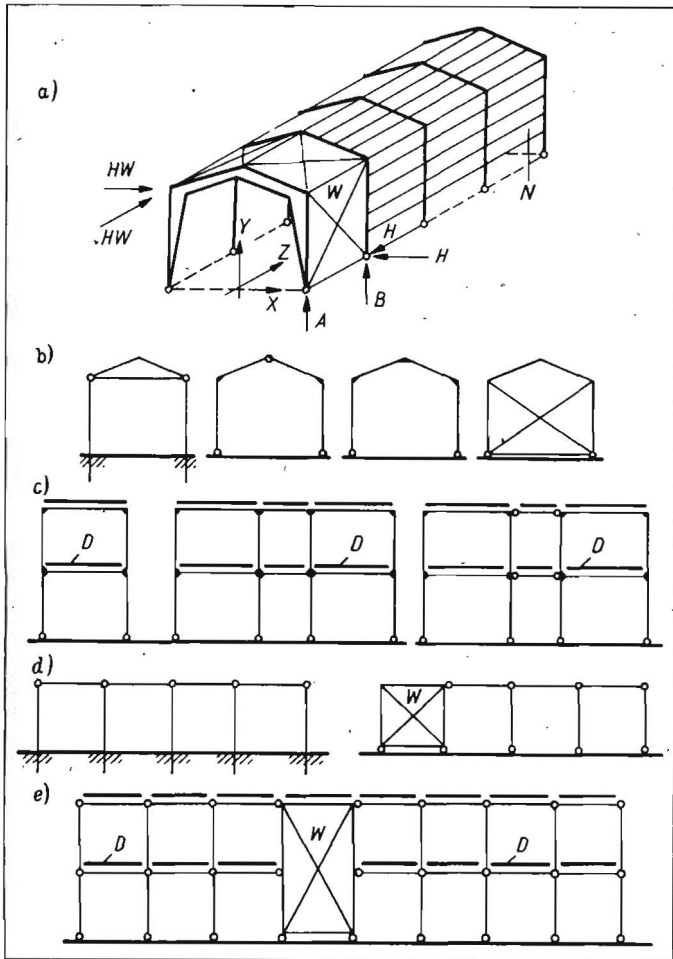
Schematische Darstellung möglicher Baukonstruktionssysteme bei Hallen- und mehrgeschossigen Skelettbauten;
